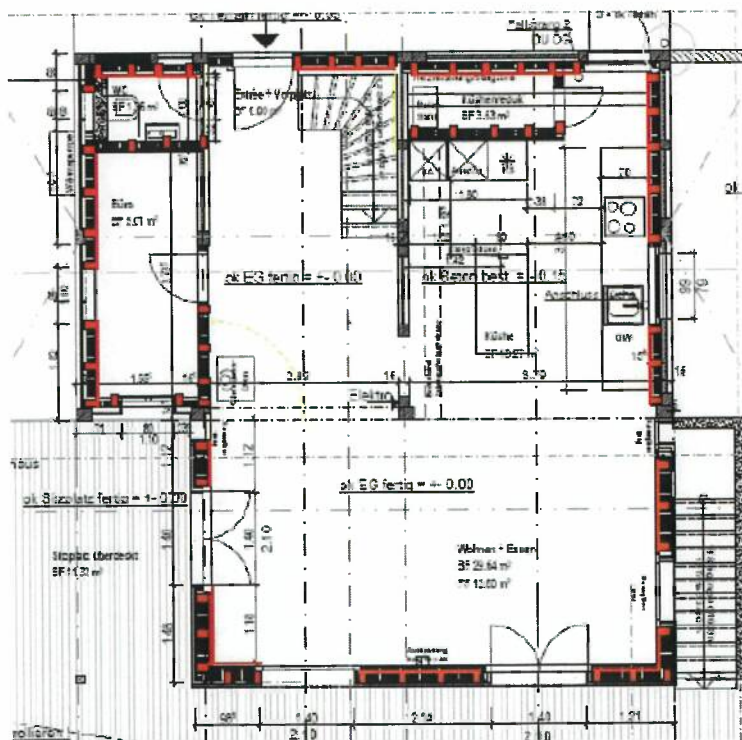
Bauteile aus Buche (rot) – Werkplan Grundriss Mst. 1:100
